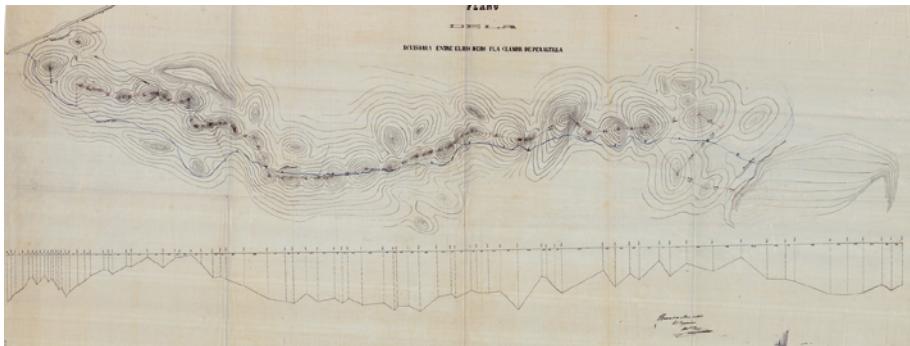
Plano firmado por el ingeniero Mariano Royo.
